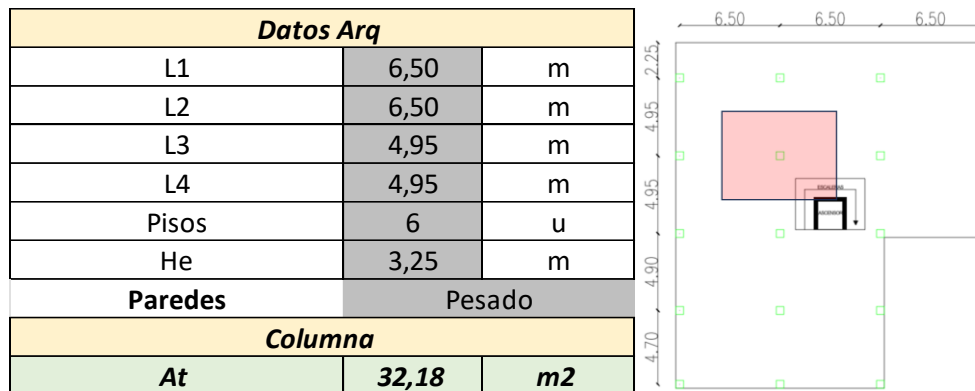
Esquema referencial de ubicación de la columna. Elaboración Propia (2025).
